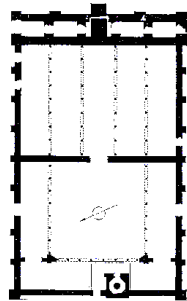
جامع ندرومة، مسقط أفقي، عن:
